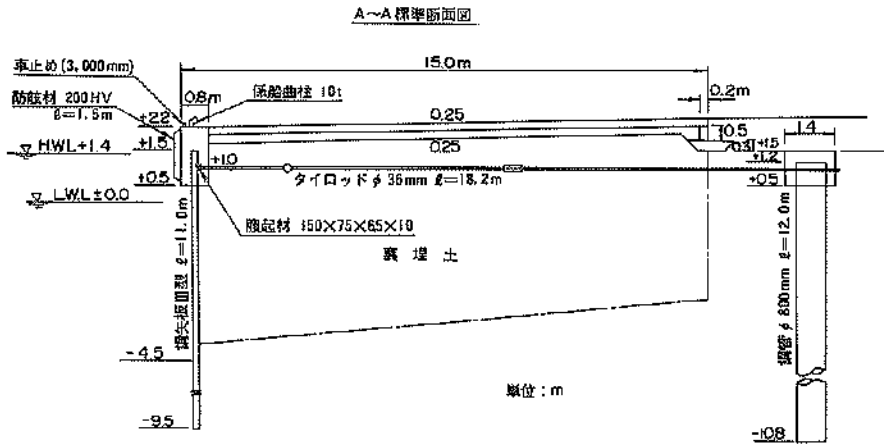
標準断面図 (③中央埠頭-4.5m 岸壁 A-A断面)
